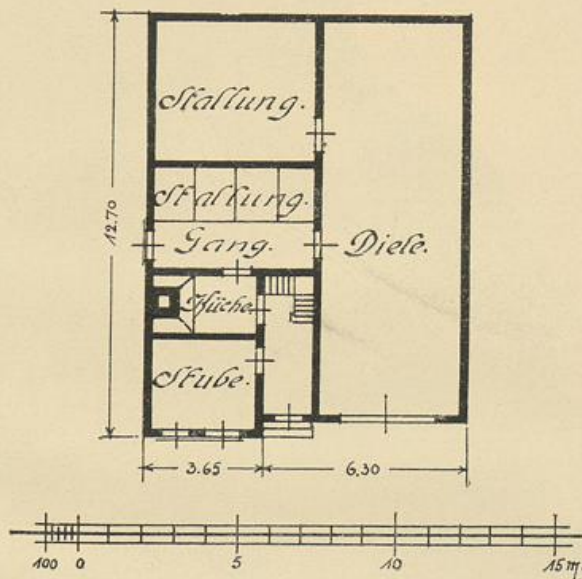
Hameln, Stubenstraße, erbaut 1696.
